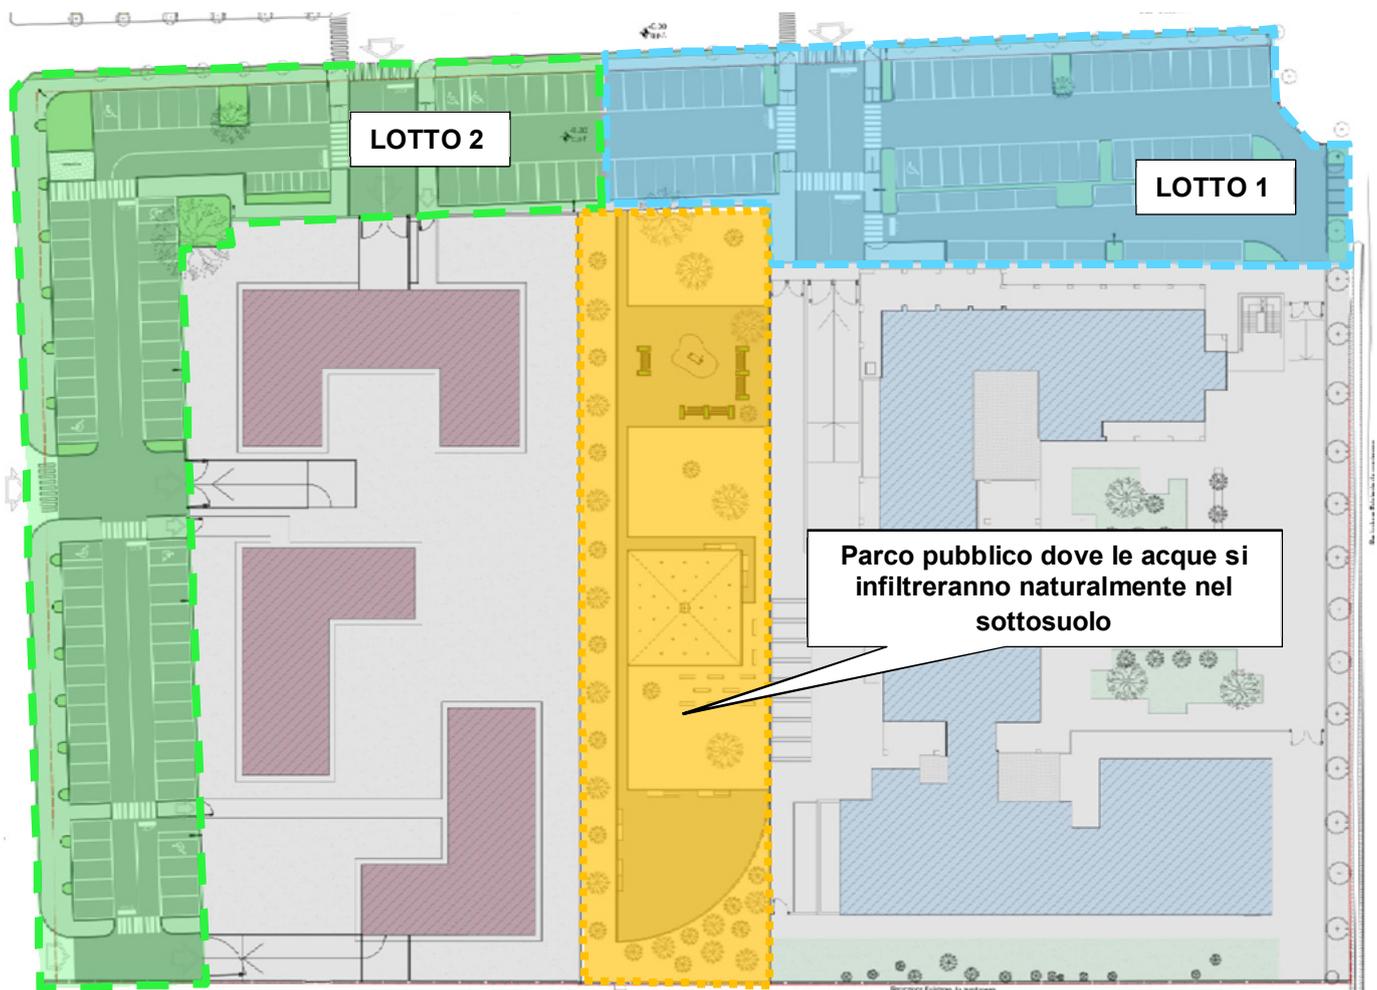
planimetria di progetto con individuazione delle aree (opere di urbanizzazione) oggetto del progetto di invarianza idraulica.
